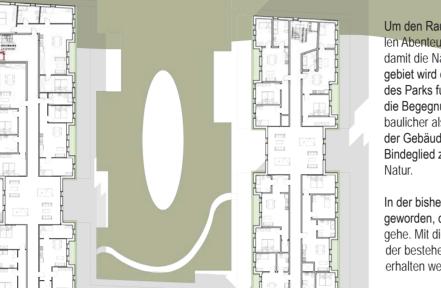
Grundriss 1:50 I Standard Geschoss
